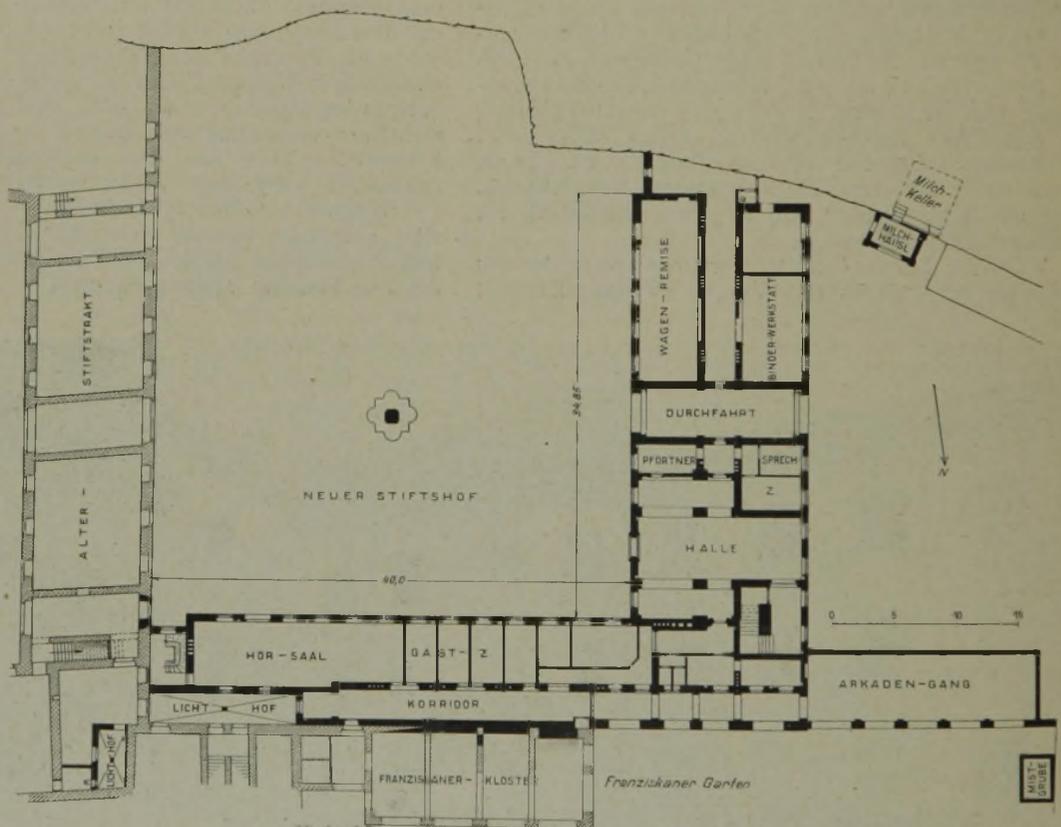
3. Grundriß vom Erd- u. 1. Obergeschoß des Salzburger Benediktiner-Kollegs. (1 : 600.)
